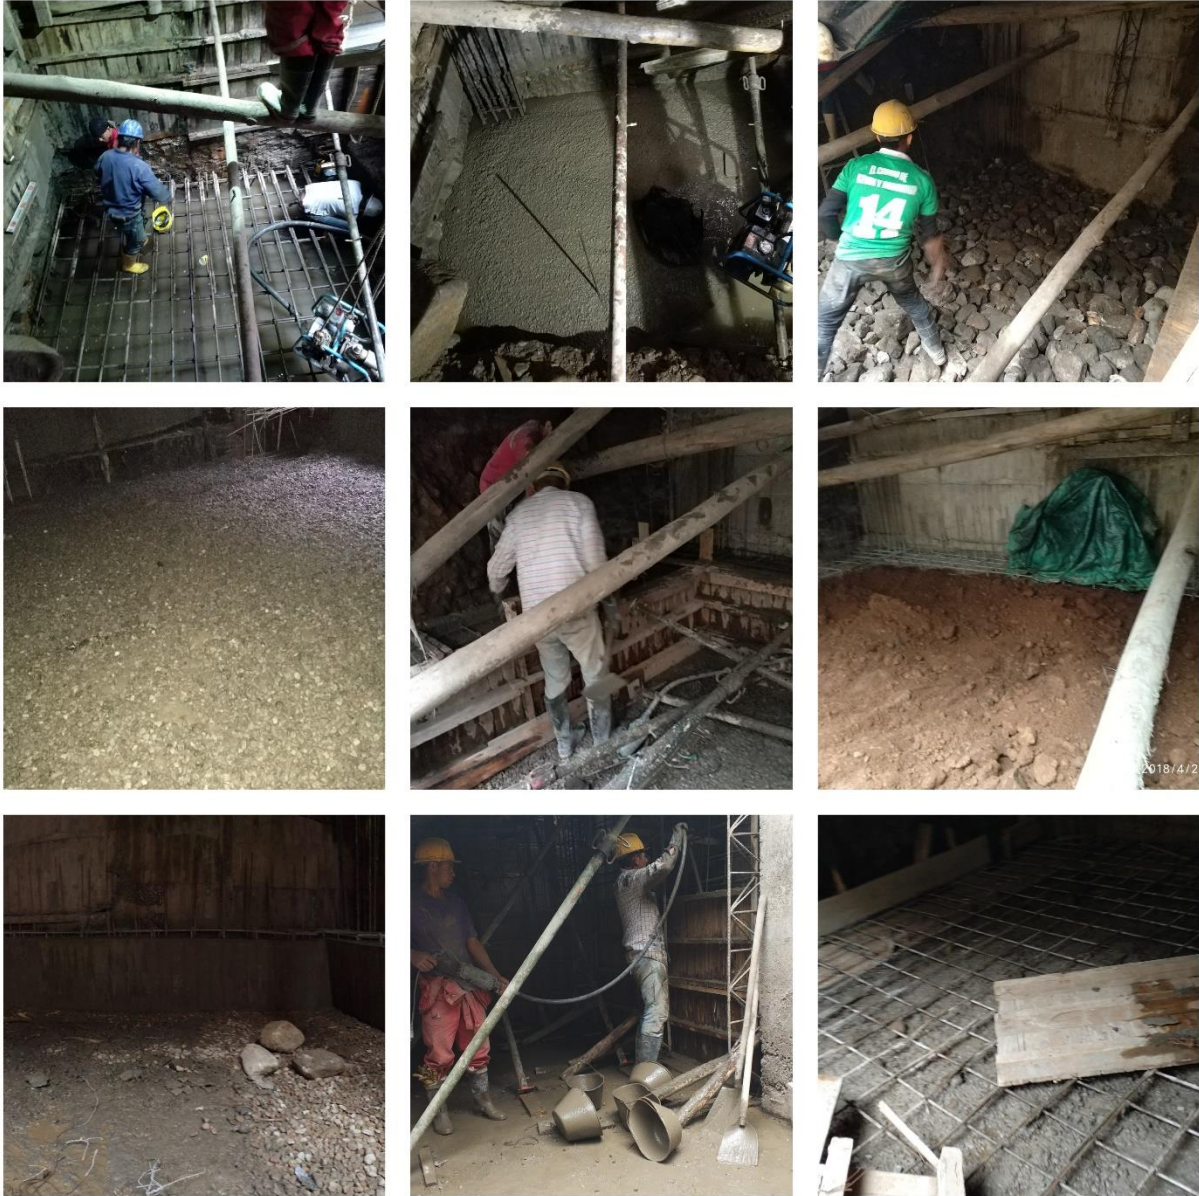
Construcción de los diferentes elementos estructurales del edificio.
